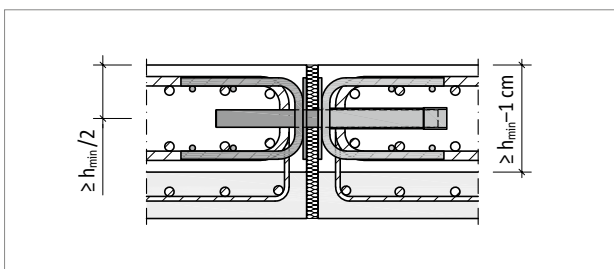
Schöck Stacon® typ SLD: Napojovací výztuž u napojení trámu
